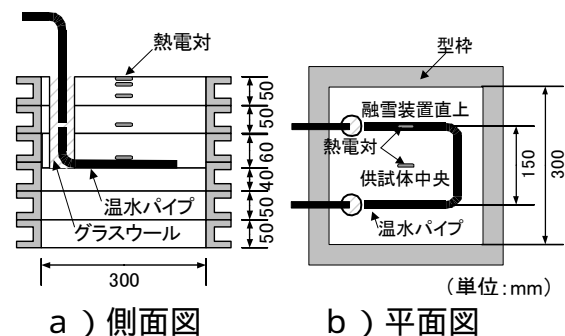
温水パイプ方式供試体(埋設深さ 160mm)
